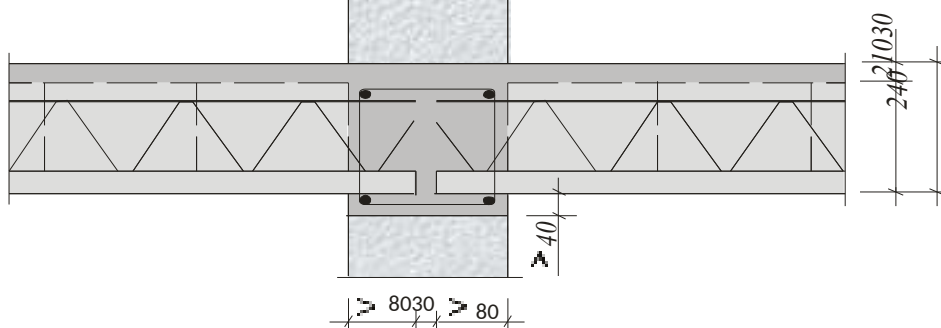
Венец, связывающий перекрытие на внутренней несущей стене, приподнятый на 4 см.
